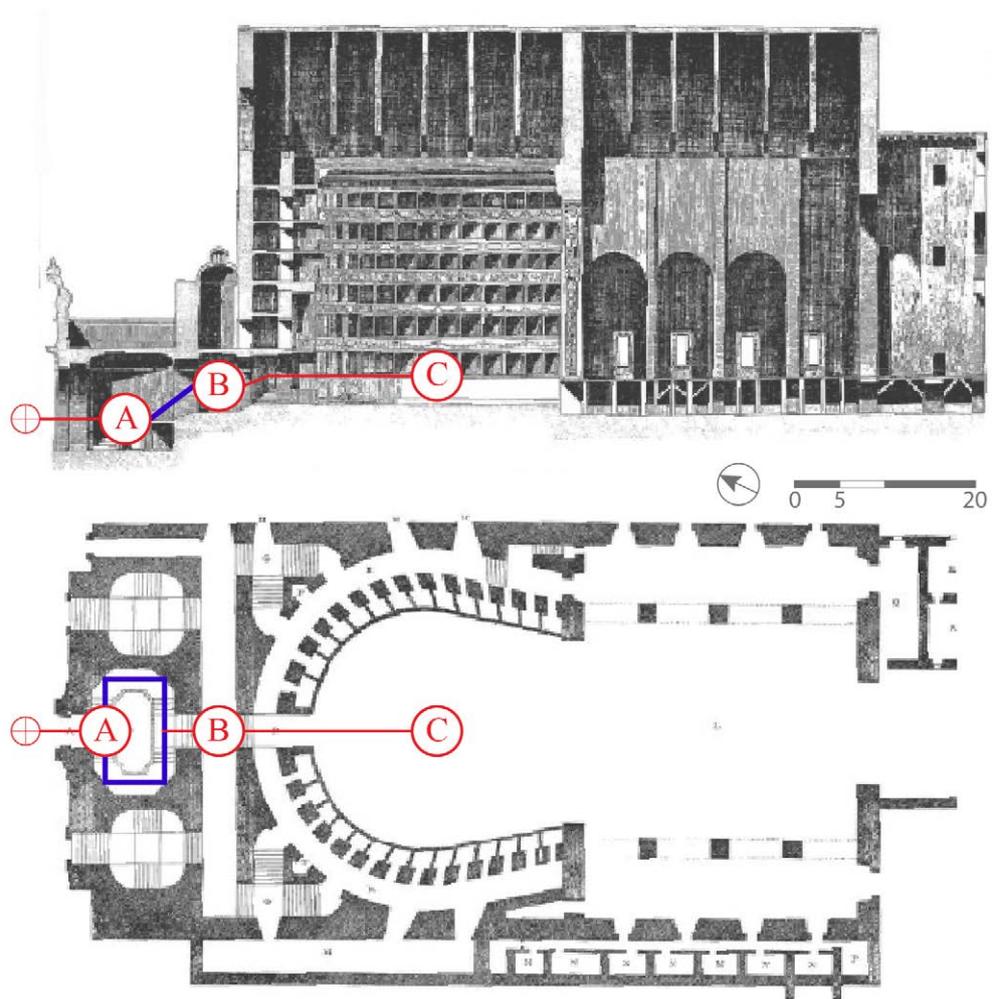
Teatro San Carlo di Napoli (G.A. Medrano, 1737): pianta e sezione (Diderot, D., & Alembert, D. (1751-1780). L'Encyclopédie, Recueil de Planche ..., 25, Théâtres, tavv. I-II) con sovrapposizione dei tratti di distribuzione. Elaborazione dell'autrice.
